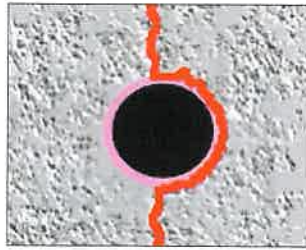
Rissbildung bei eingemörtelten Bewehrungsstäben (nach [11])
